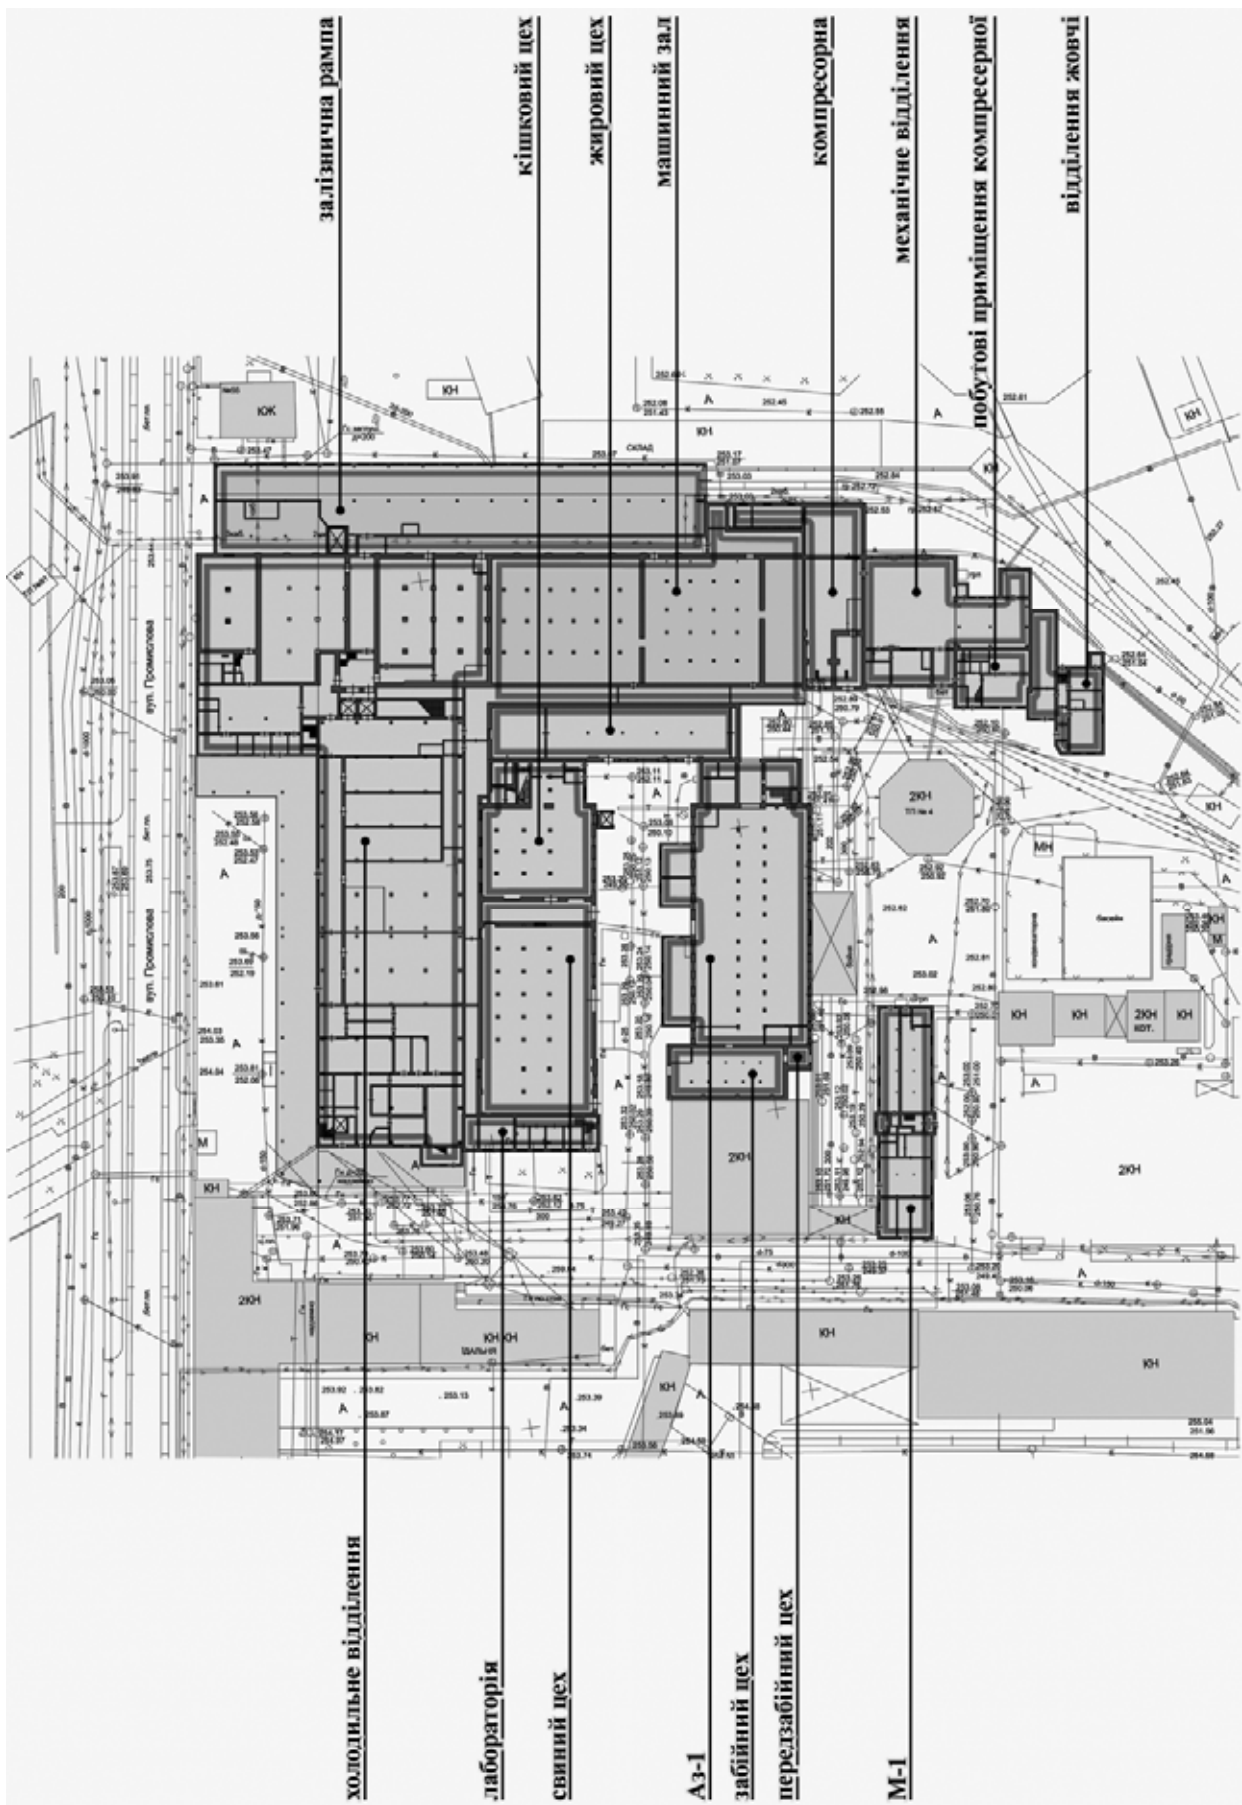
Фрагмент генплану м'ясокомбінату з відкритим планом 1-го поверху
